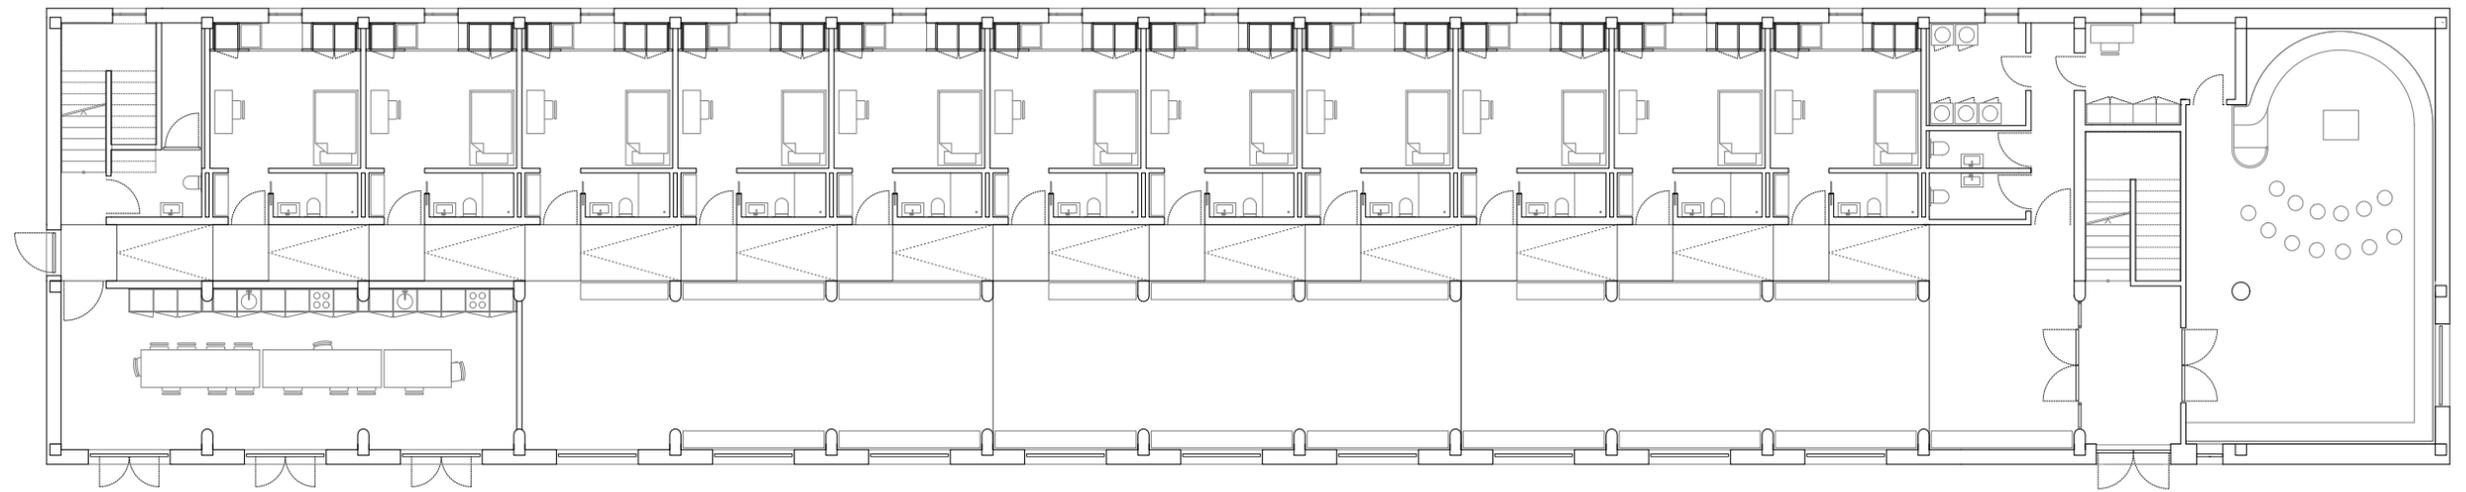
Grundriss Erdgeschoss, M 1:200
